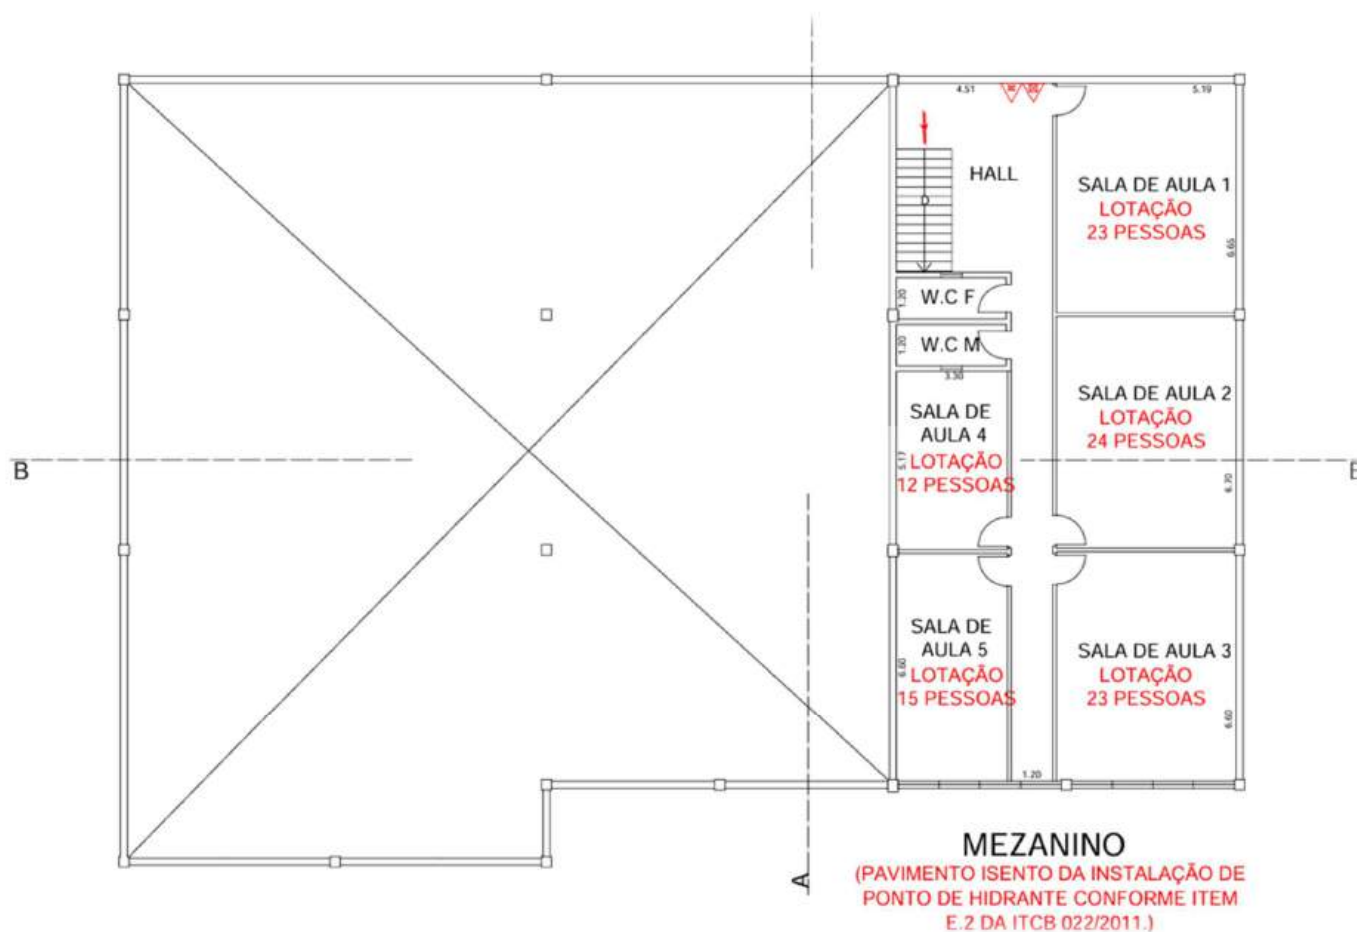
Planta Pavimento Superior ou Mezanino. Fonte: projeto técnico de segurança contra incêndio. Eng^a. Flávia Togni Trezza.
